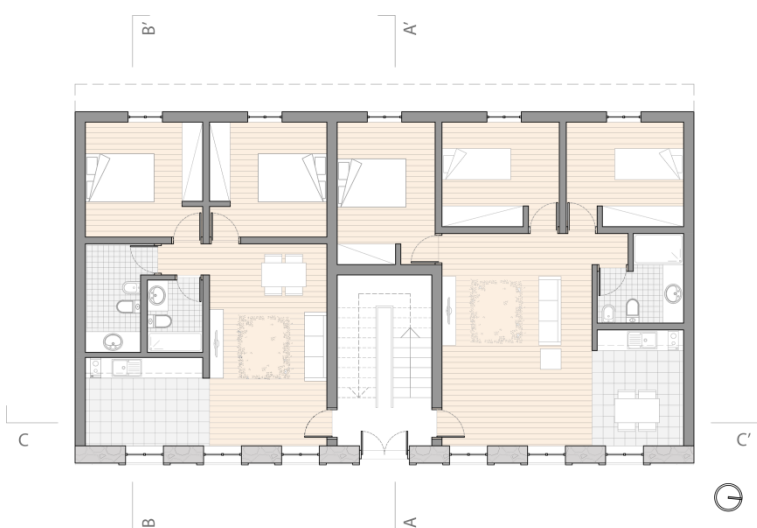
SOLUÇÃO B: Planta Piso Térreo
